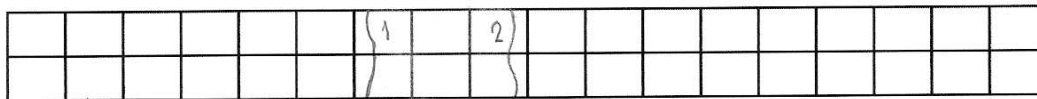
Fisuras observadas en la viga 17.
